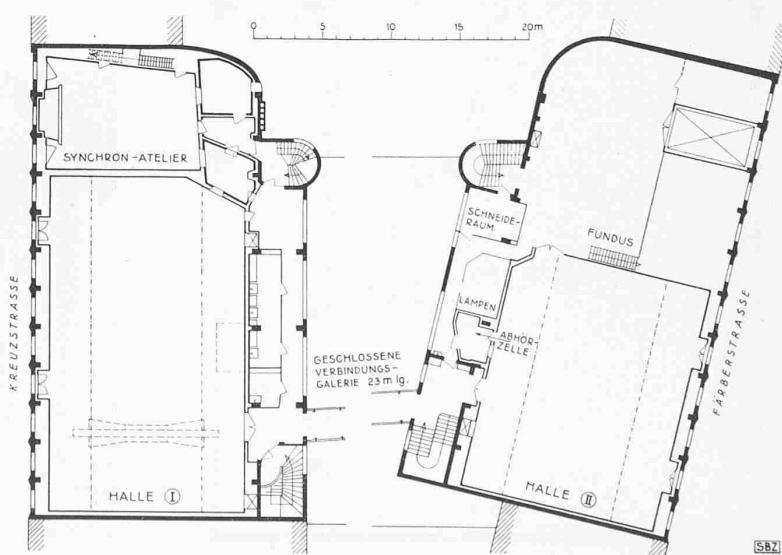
Grundriss der Film-Ateliers im Bellerive Zürich. — 1:500
